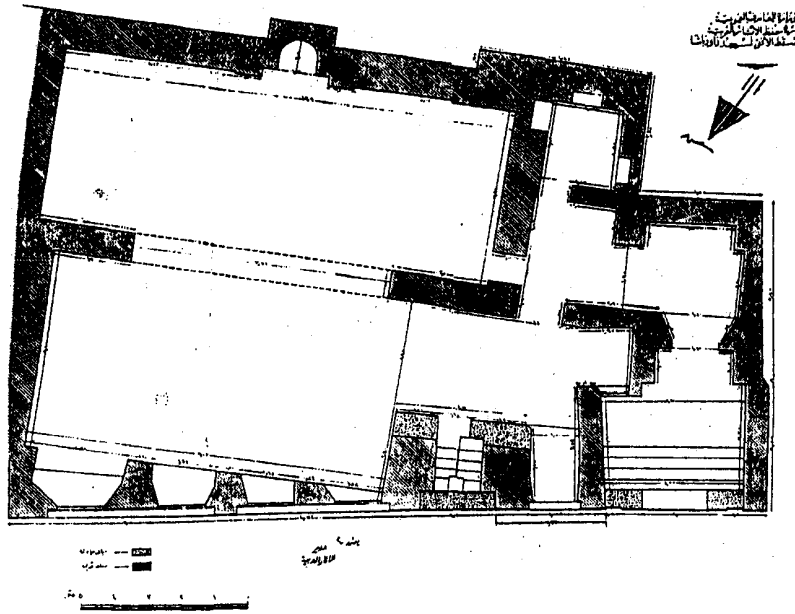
مسقط أفقي لجامع التي برمق بالقاهرة .
